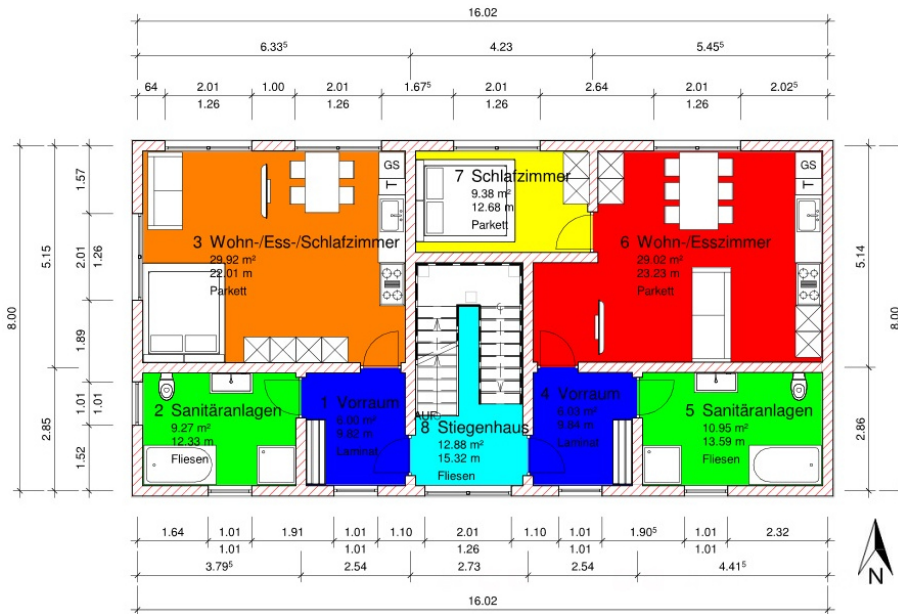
Bestand - Grundriss 1.OG
